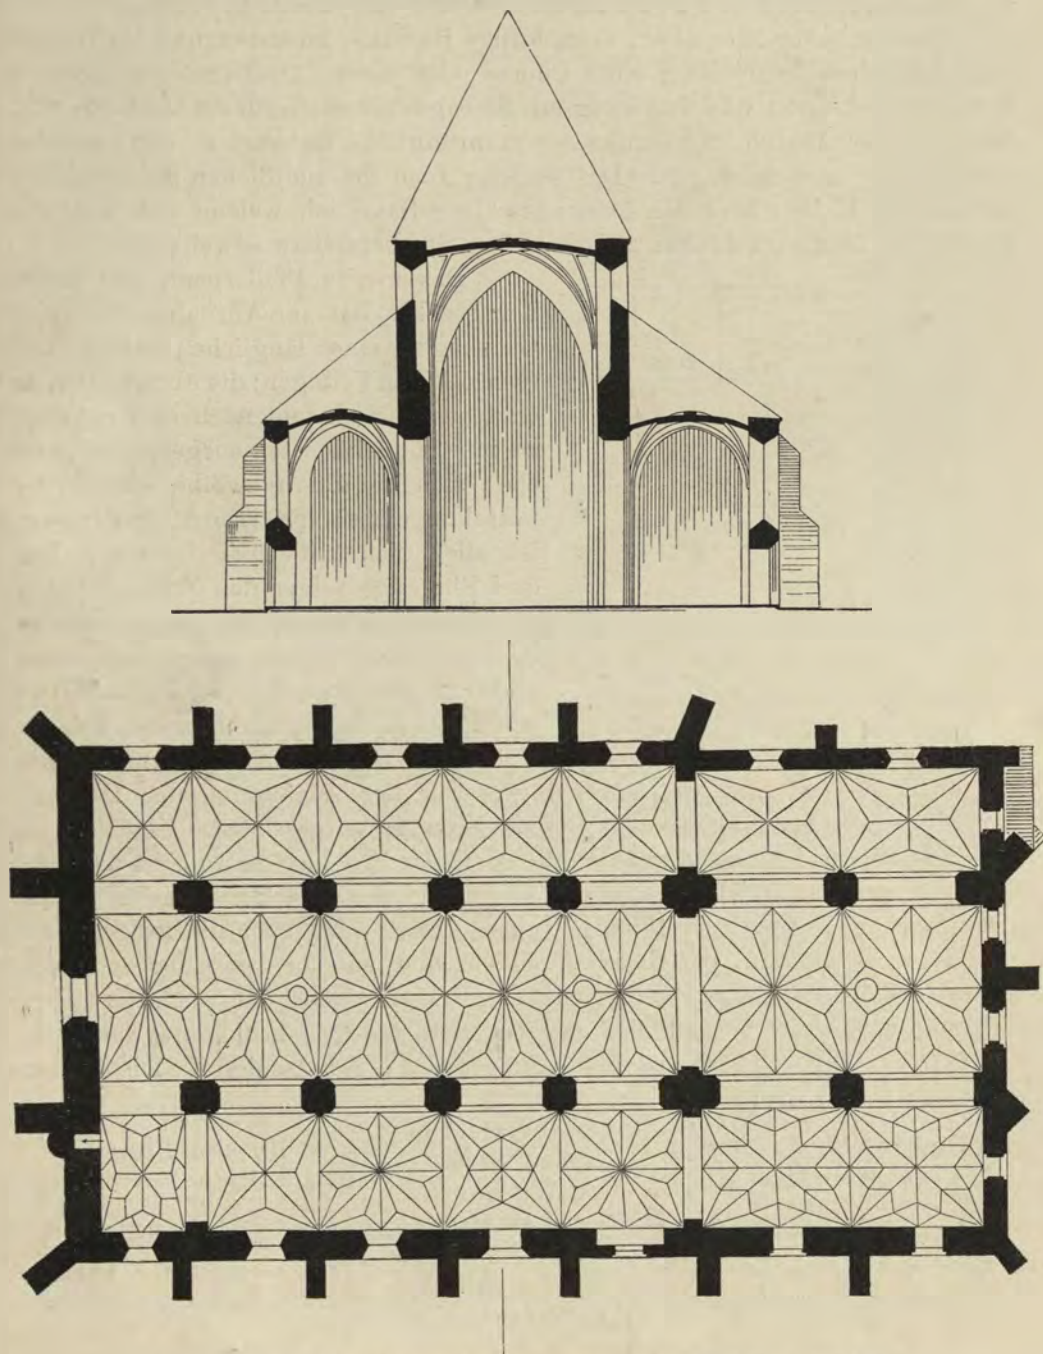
42. Katholische Pfarrkirche in Samter. Grundriss und Schnitt.
